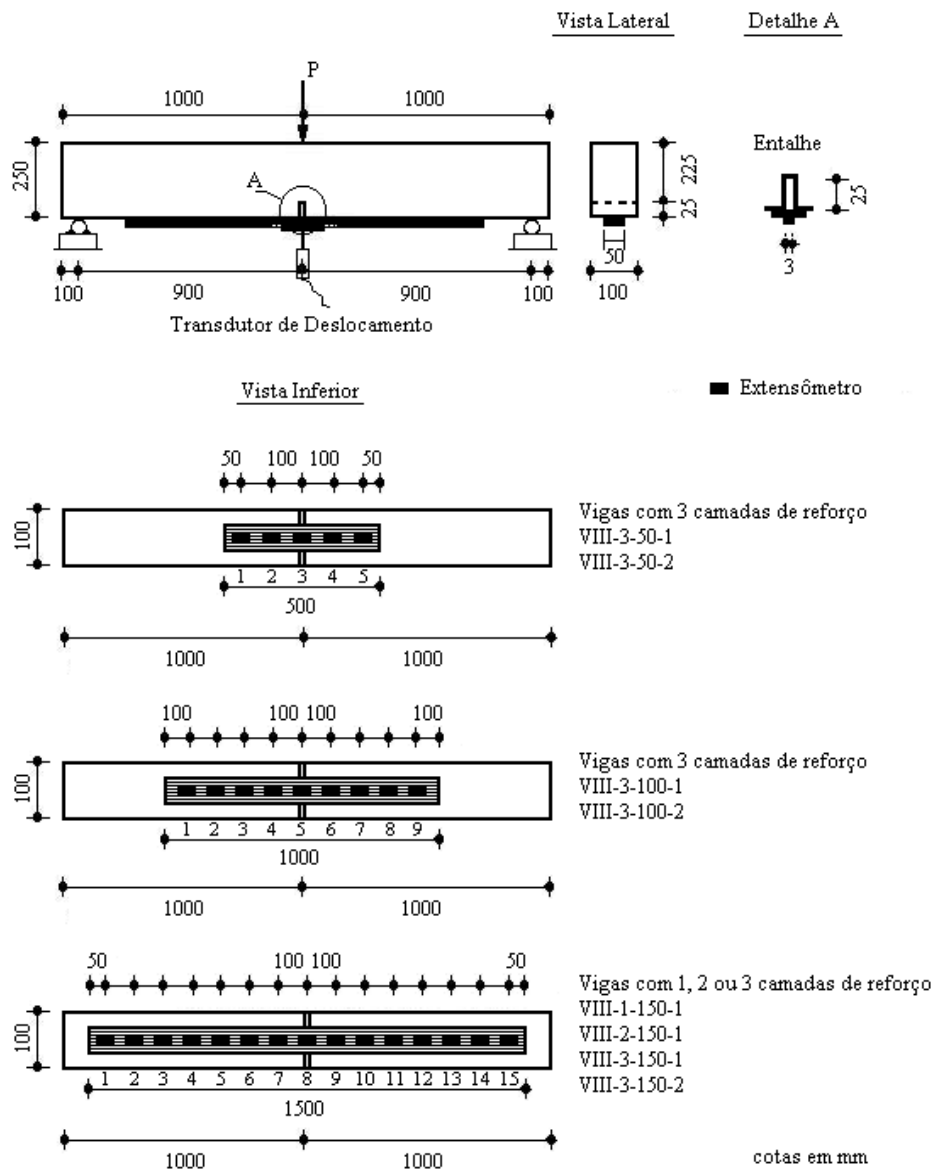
Instrumentação Externa das Vigotas de Concreto Armado
